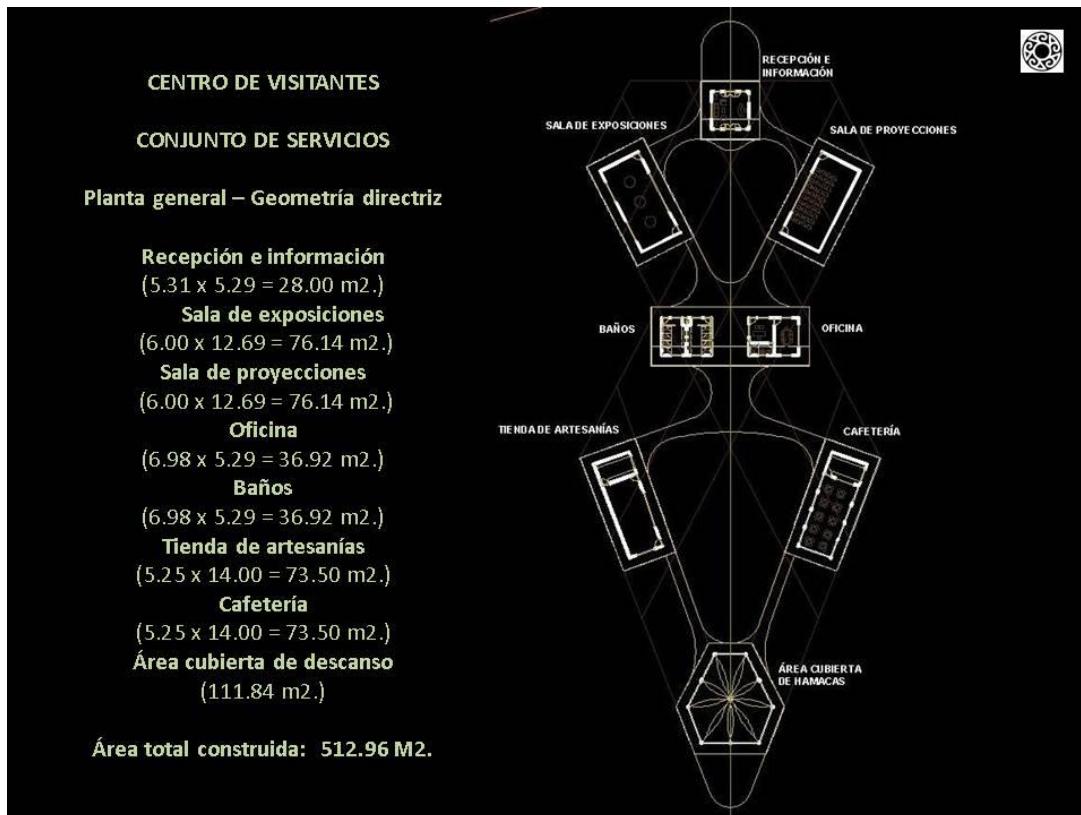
PLANTA GENERAL DEL CONJUNTO DE SERVICIOS
